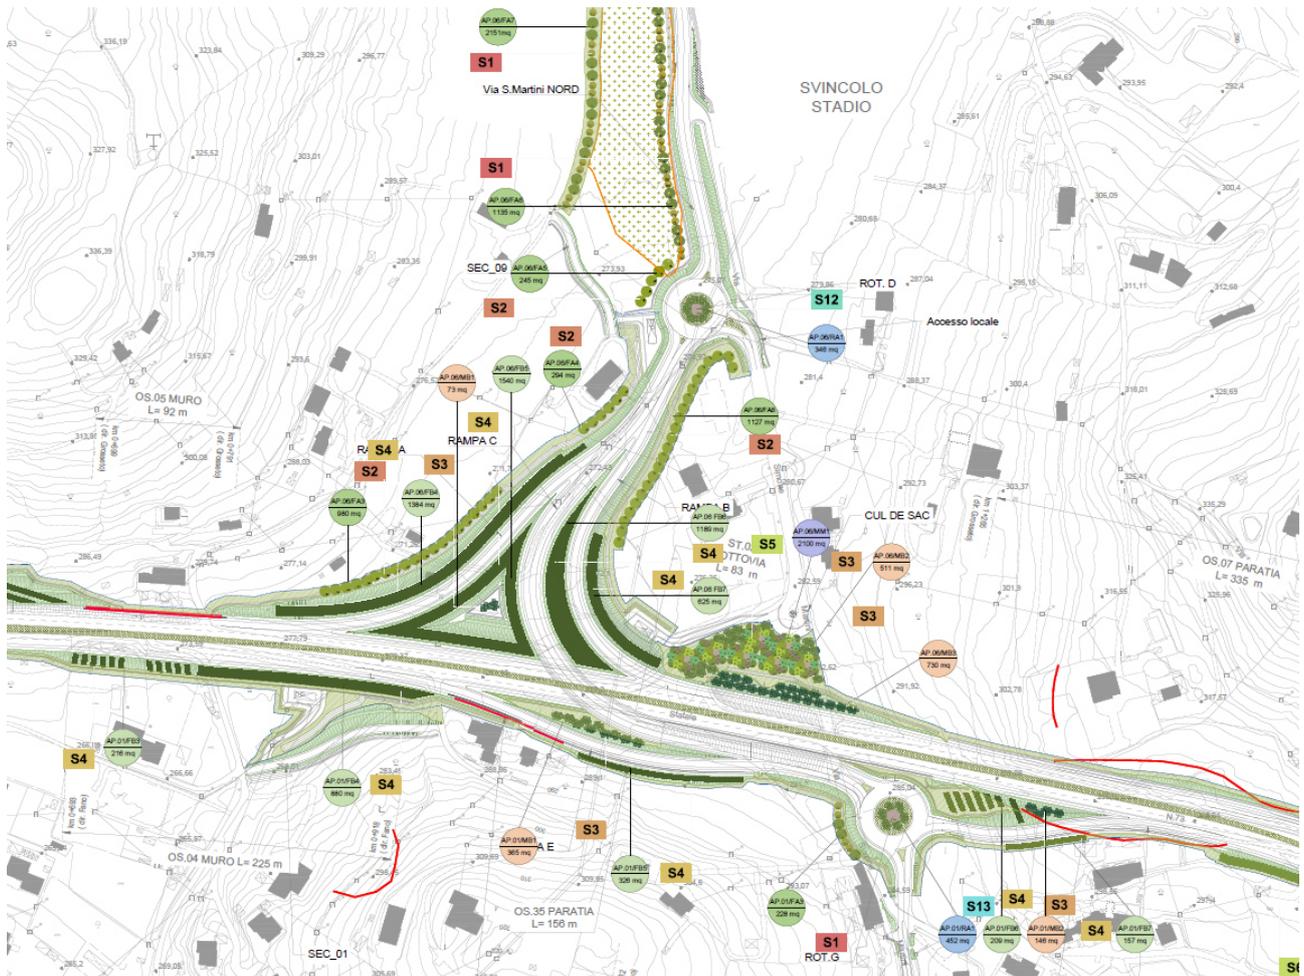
Stralcio della planimetria delle opere a verde, svincolo “Stadio”
